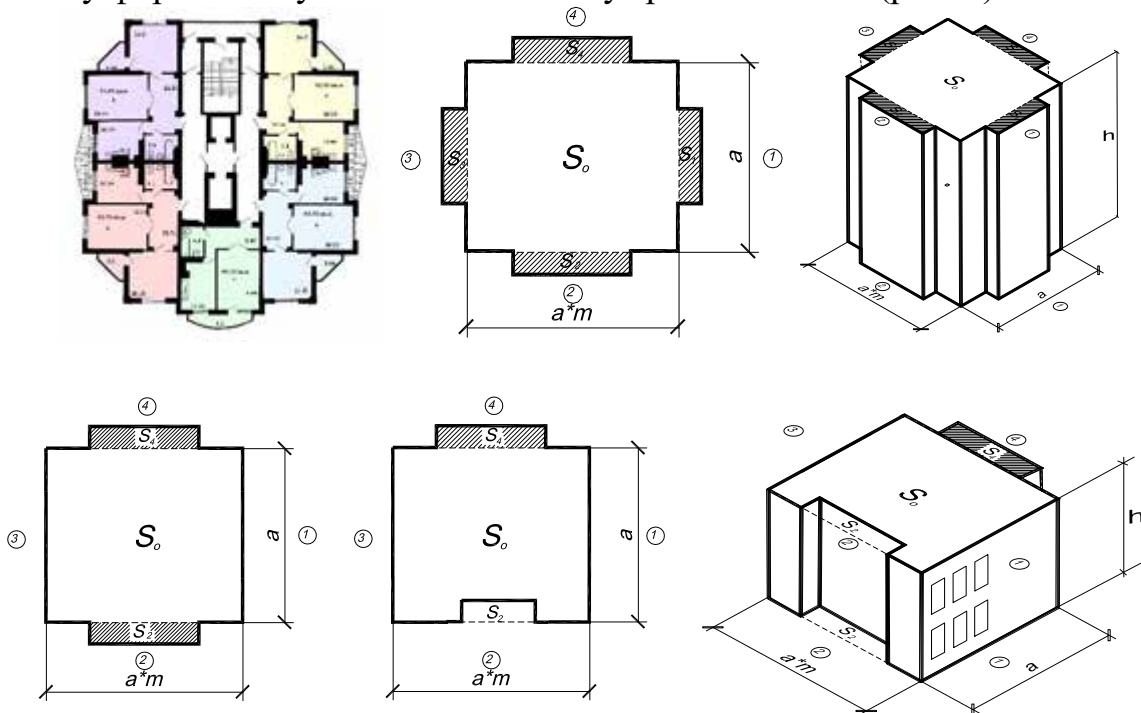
Багатоповерхова будівля з прямокутною формою плану зі зрізаними стінами
